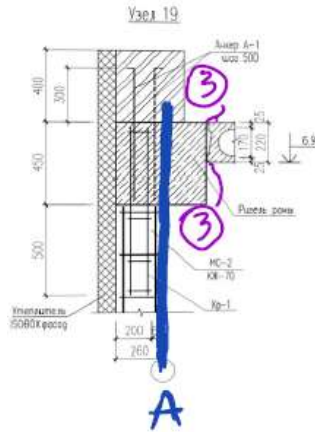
Вертикальное сечение наружной части здания (вдоль оси 1 согласно рабочему проекту – лист чертежа 81)
